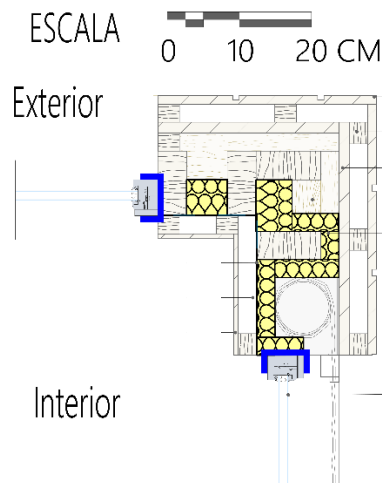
Localización de carpintería y contraventana en capa de aislamiento (vista en corte).
